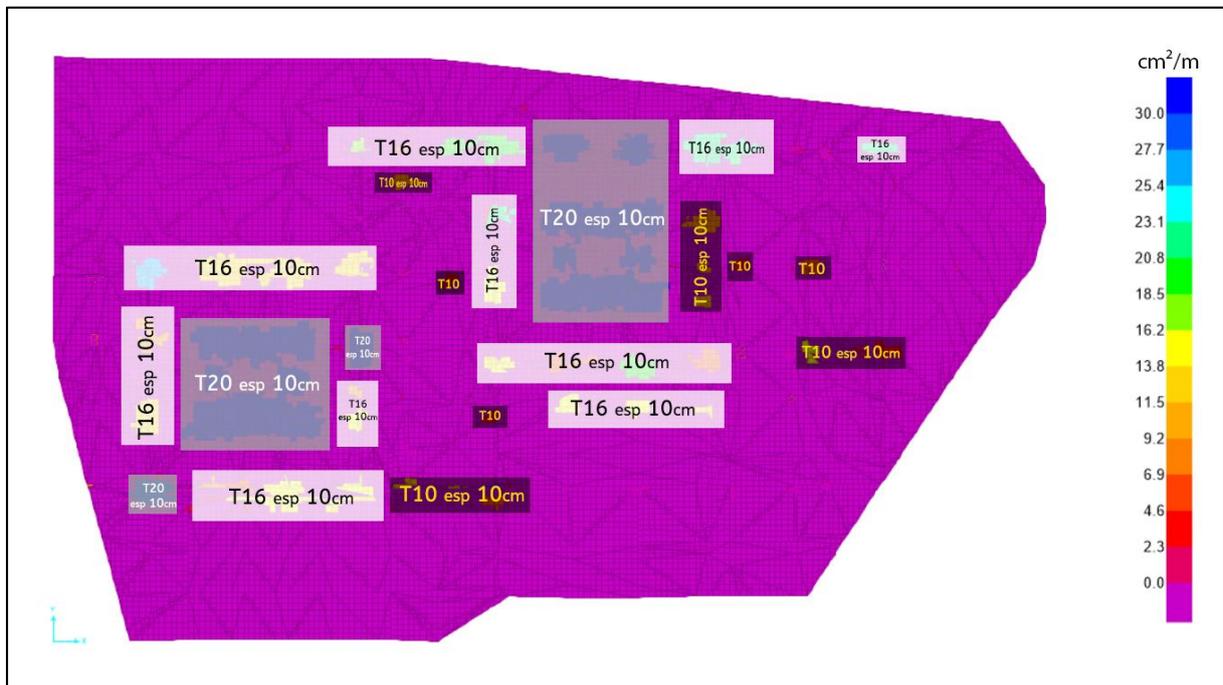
Renforts du ferrailage inférieur suivant la direction 2 (y).
